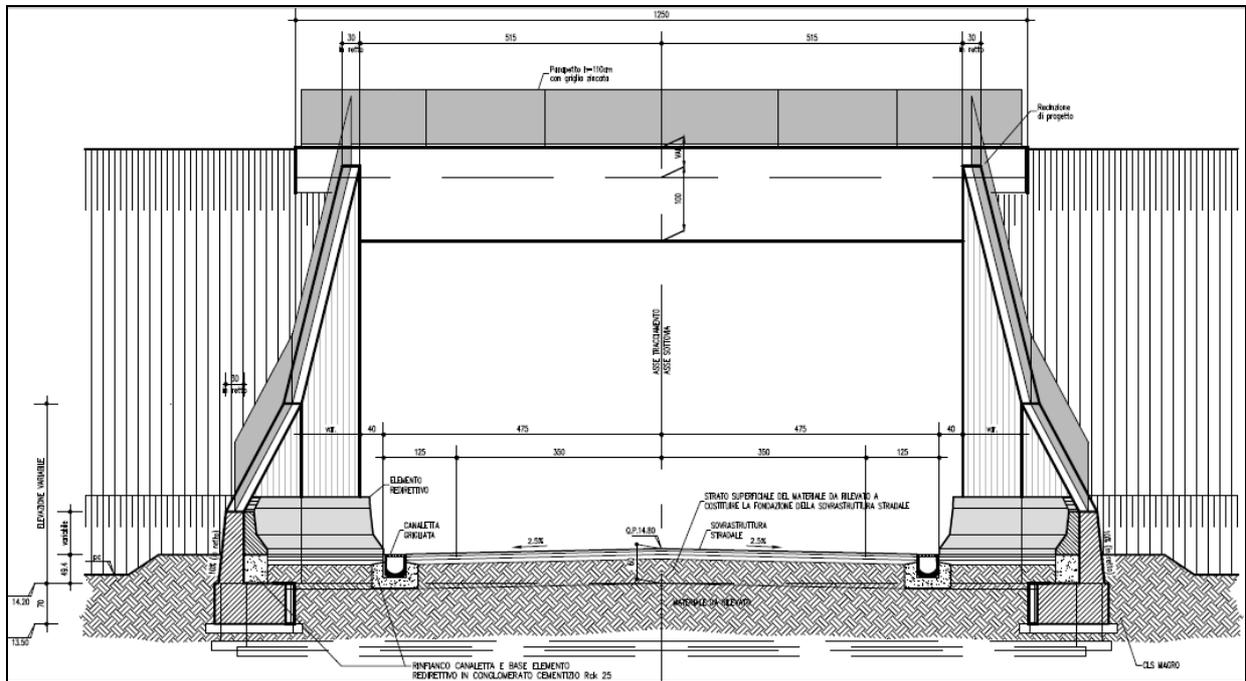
SEZIONE TRASVERSALE SUI MURI DI IMBOCCO AD "L"
